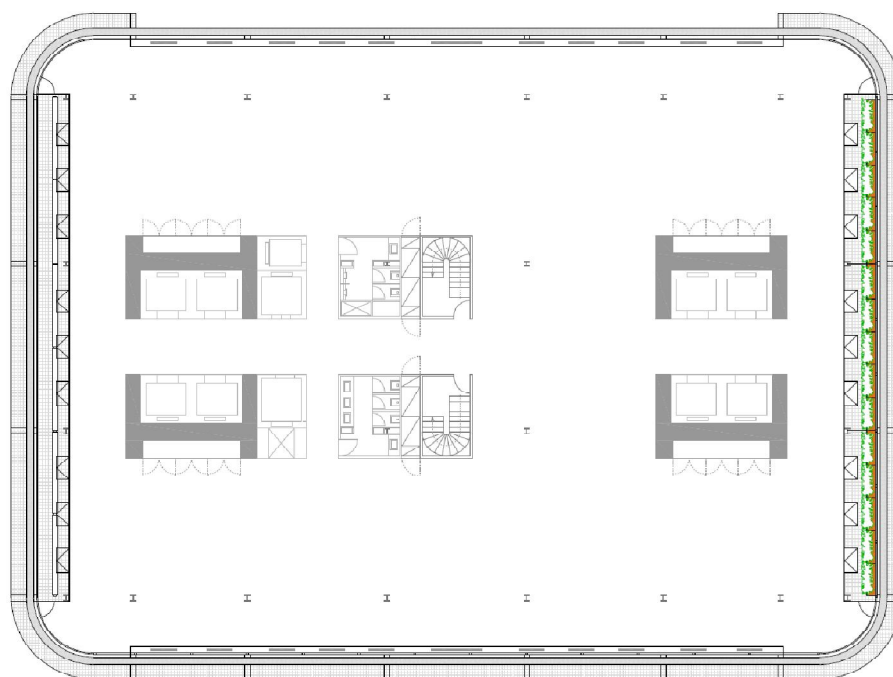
Planta tipo com a introdução da barreira vegetal na fachada Este e lâminas reguláveis na fachada Oeste. Imagem do autor.
